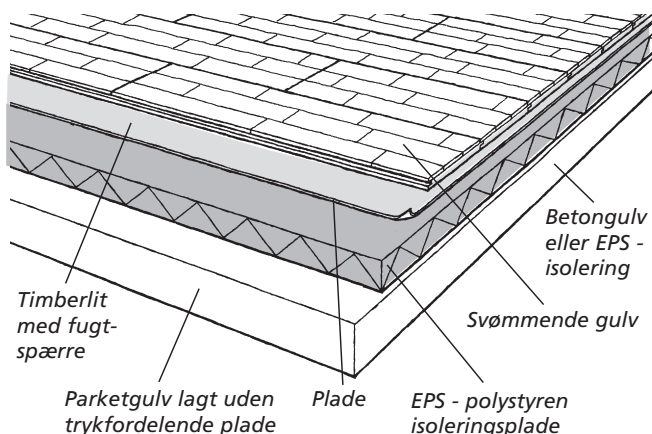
Tegningen viser polystyren lagt på beton eller EPS-isolering som underlag for svømmende 14 mm Timberman Lamelparketgulv lagt uden trykfordelende plade.
